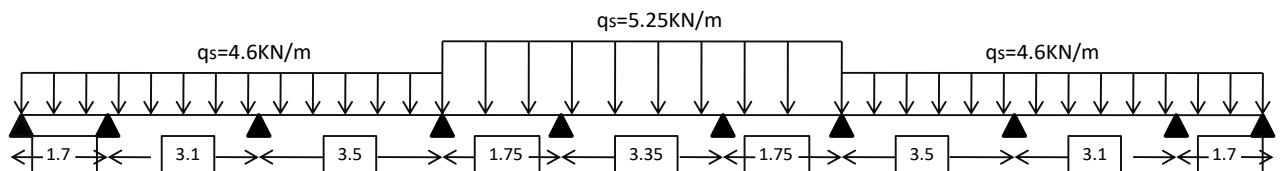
Schéma statique de la poutrelle à L'ELS
